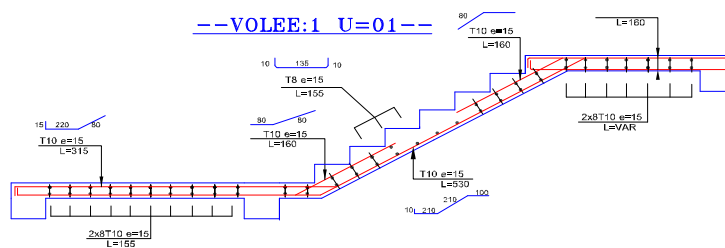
Schéma de ferrailage des escaliers (volée 1 et3).
